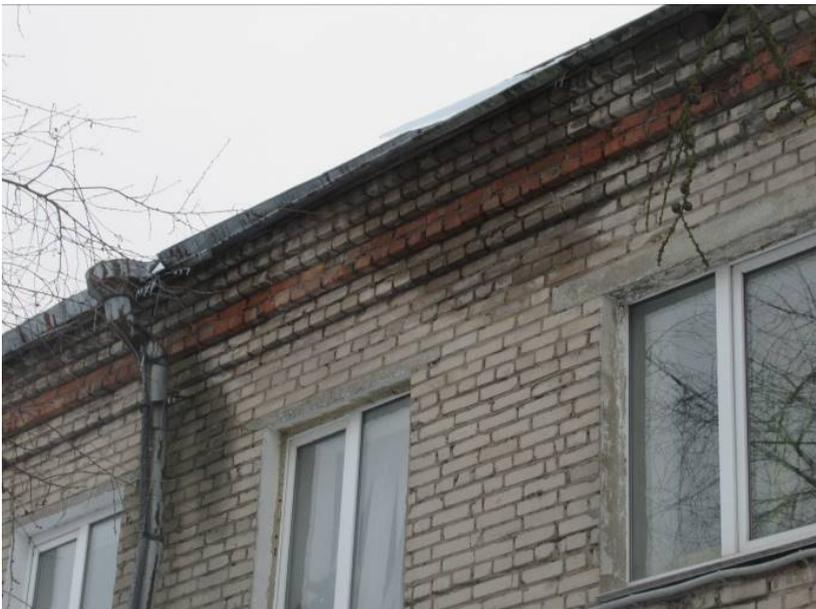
Вид состояния фасадной стены здания. Присутствует намокание кладки вследствие протечек кровли.
